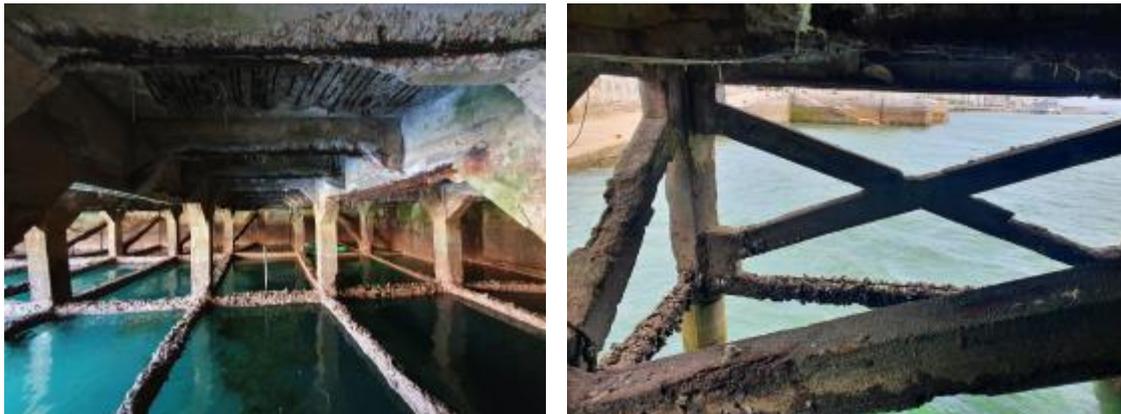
Patologías en el Muelle de Maura en techos (izquierda) y en las vigas y riostras de la estructura porticada de hormigón (Fotografías de [8] y [14]).
